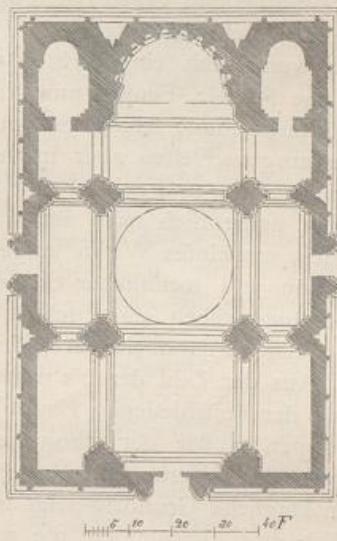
Kathedrale zu Ani (Grundriss.).
